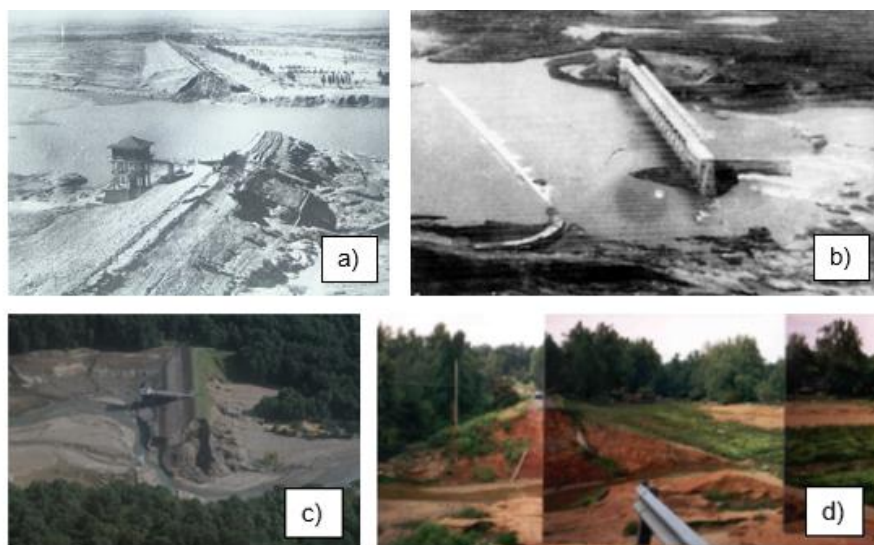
Exemplos de roturas relevantes por galgamento de barragens de aterro.
